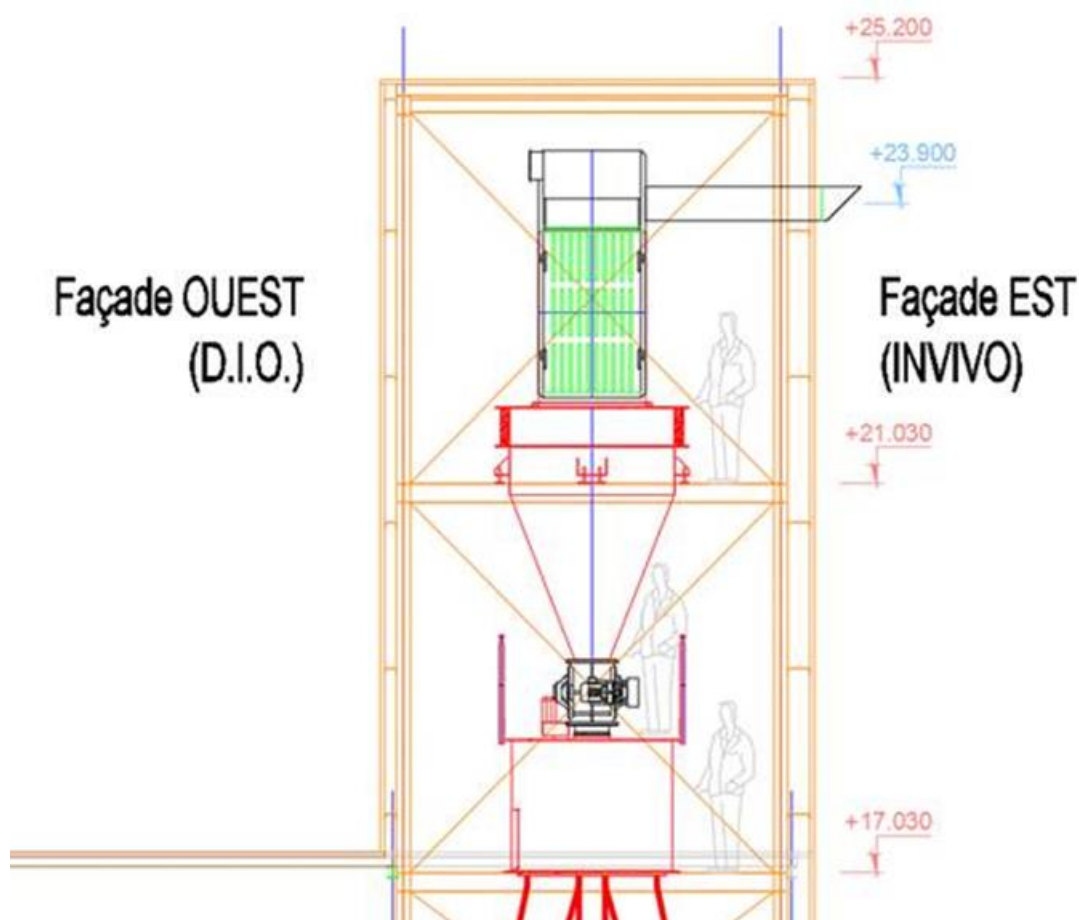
Plan de coupe de l'extension du chargement vrac (source : BLG Entreprise)
